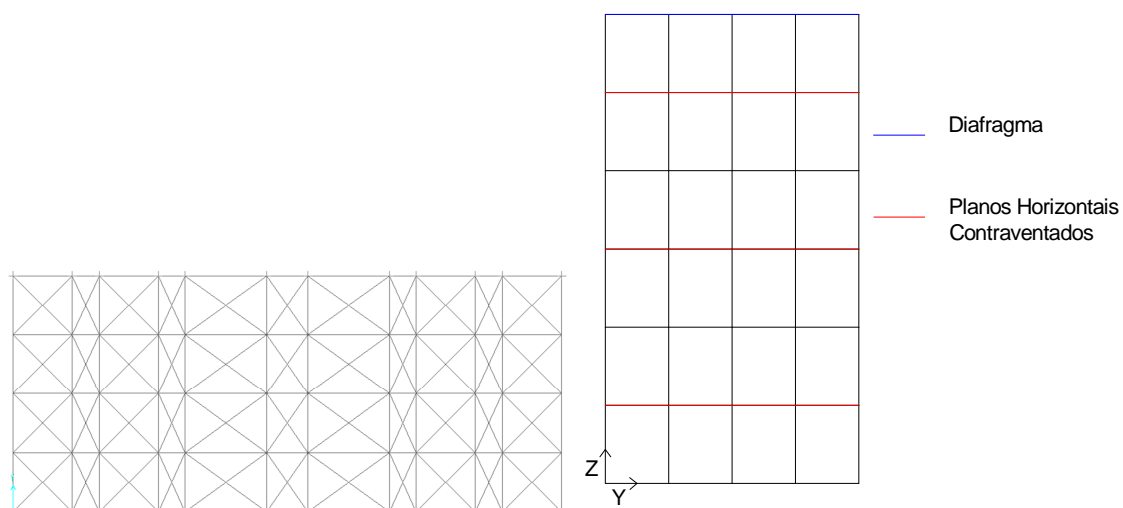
Configuração dos Planos de Contraventamento Horizontal Com Elementos de Contraventamento Pequenos
